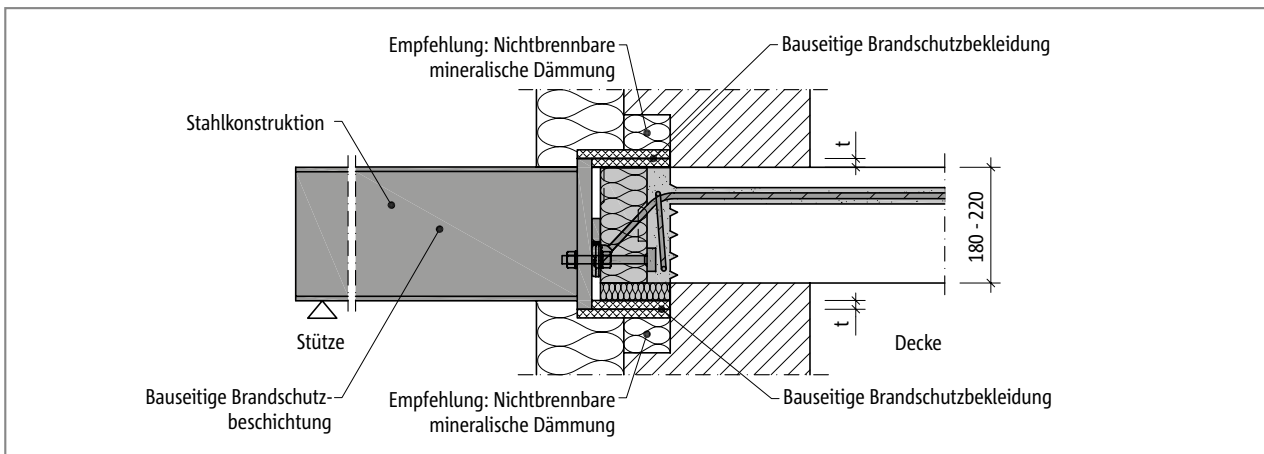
Schöck Isokorb® RT Typ SQP: Bauseitige Brandschutzbekleidung RT Typ SQP und brandschutzbeschichtete Stahlkonstruktion; Schnitt
